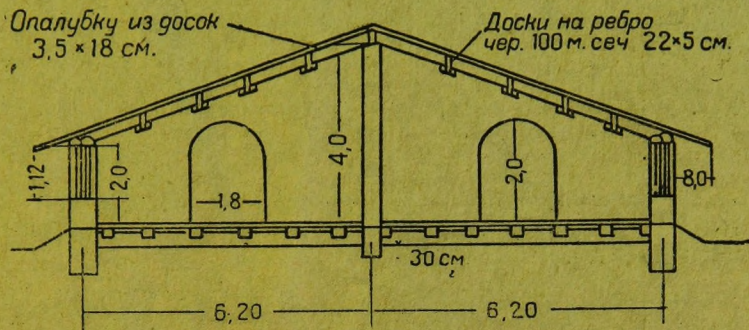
Разрез землечитного барака с поперечными стенами. Заложение фундамента под средней стеной на 30 см ниже уровня земли
